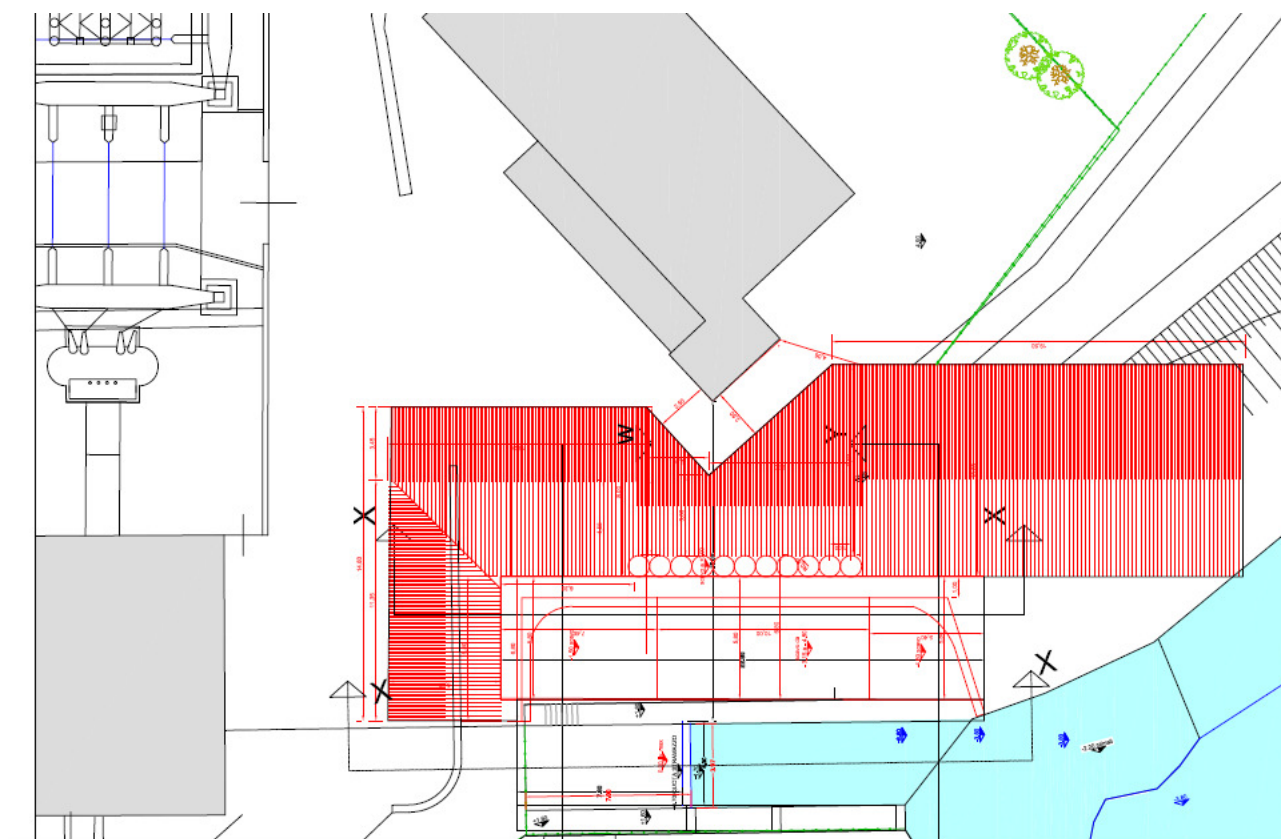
Planimetria pianta di sbancamento dell'intervento in progetto
